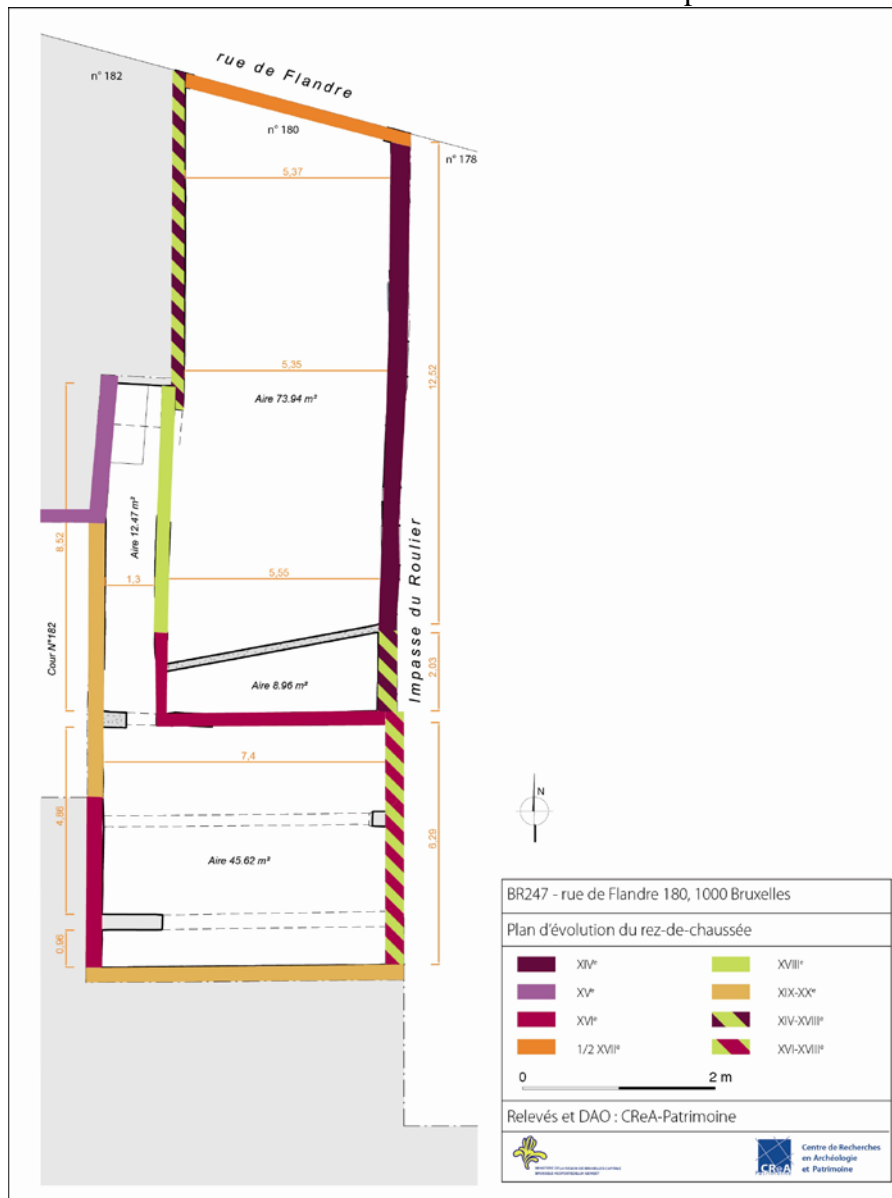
Plan d'évolution du rez-de-chaussée (Relevés et DAO : S. Delcros, N. Bloch)
